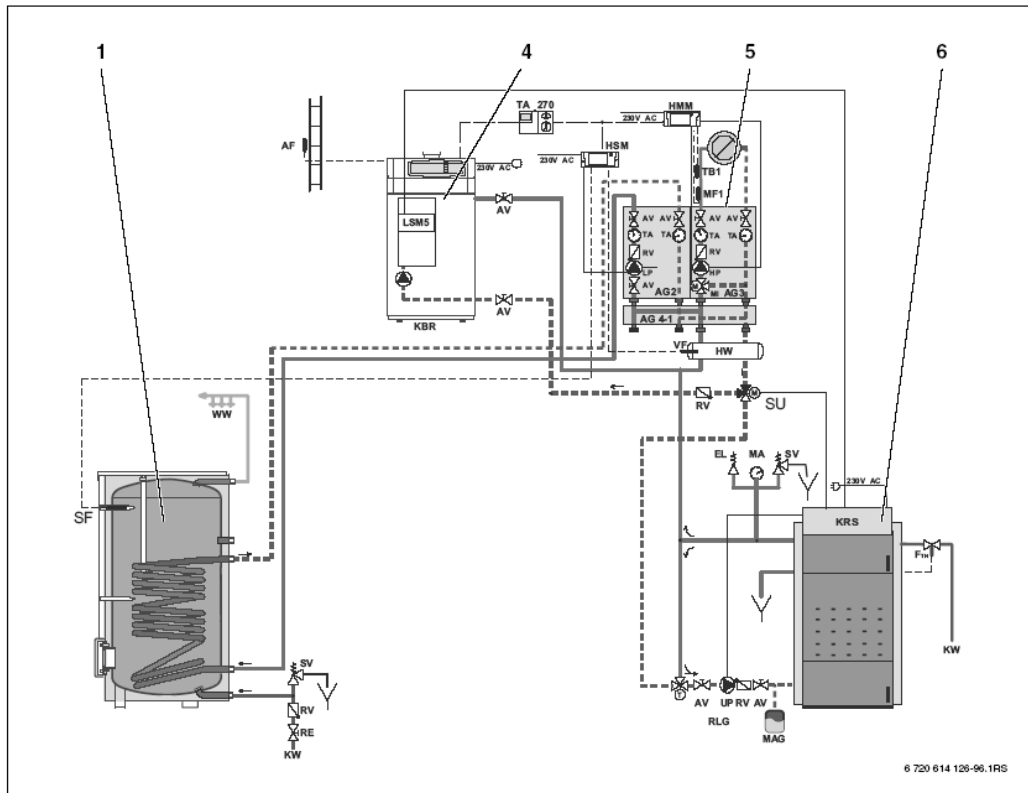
Plan hidraulic P01 cu boiler apă caldă menajeră și un al doilea cazan de încălzire
